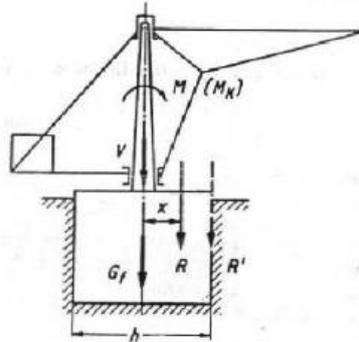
Planteamiento de la cimentación. (Fuente: (Miravete & Larrodé, Grúas, 1996))
